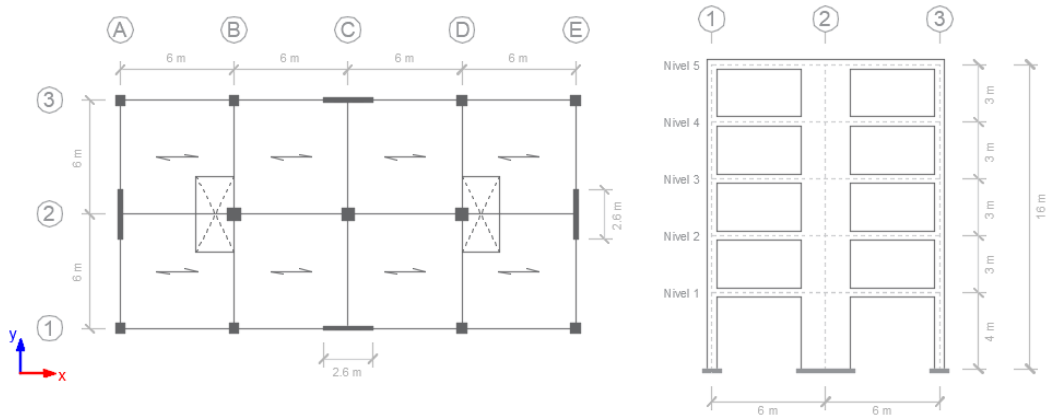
Configuración en planta y en elevación para el modelo analítico del edificio Edi-05
